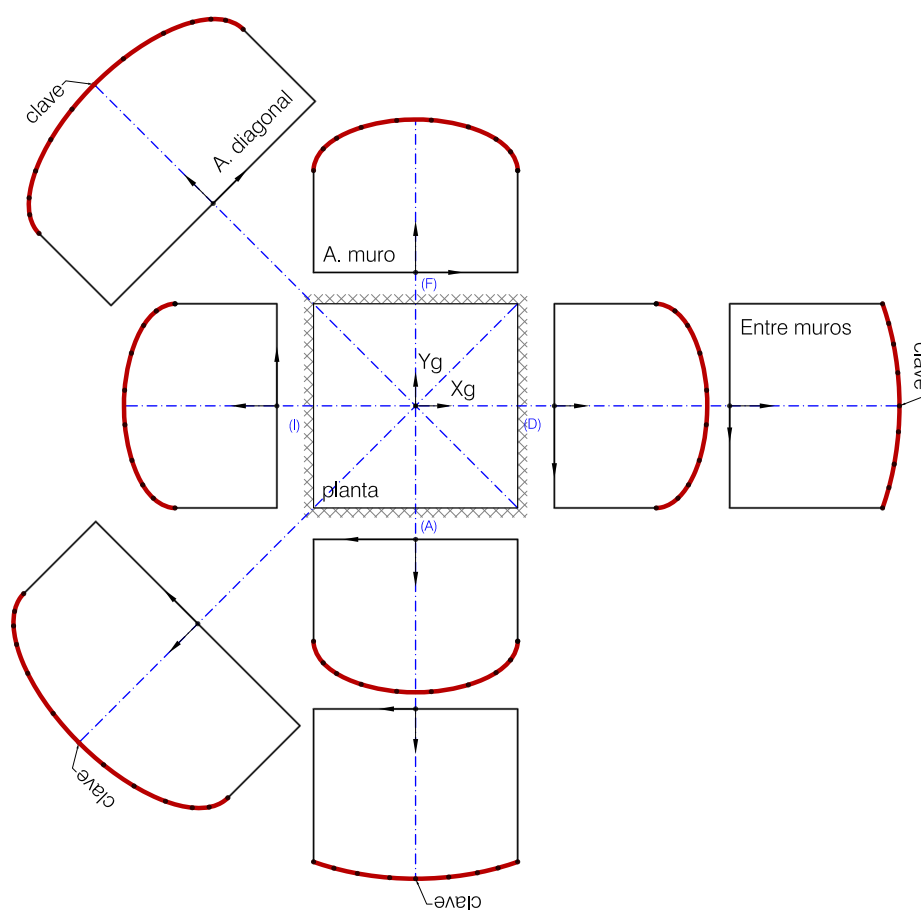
Plano general de los elementos geométricos definidores —de las secciones del levantamiento— de la forma de la bóveda: aristas en muros, diagonales y secciones entre muros abatidos sobre el plano de planta.
